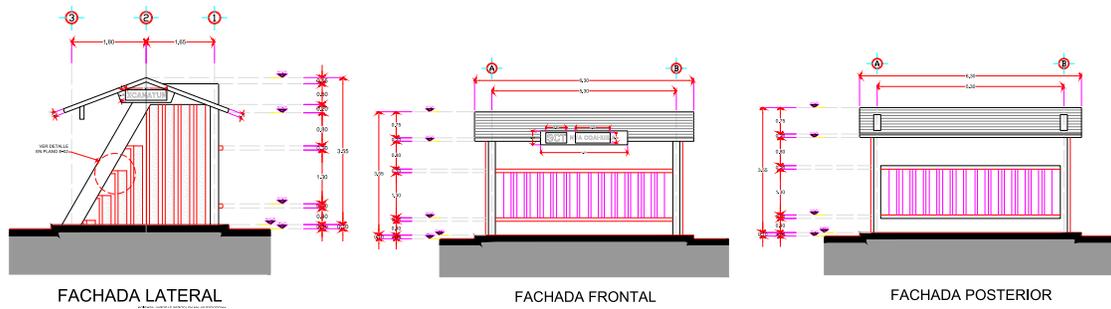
Fachadas: frontal, posterior y lateral de paraderos
